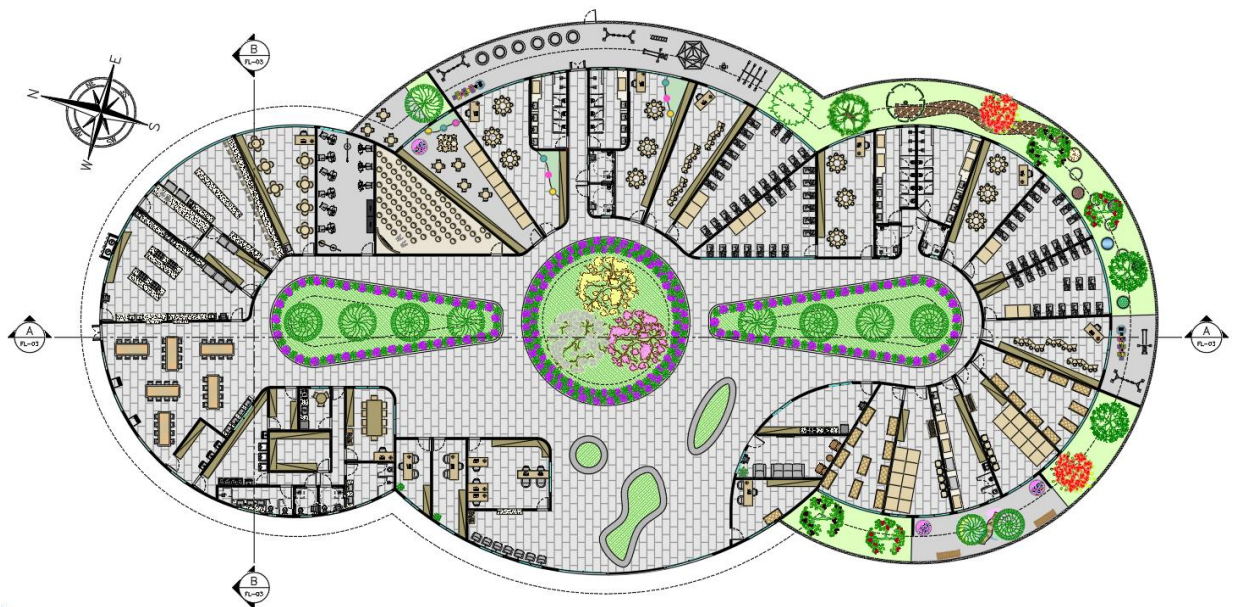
Planta baixa. Fonte: produção da autora, 2025.
